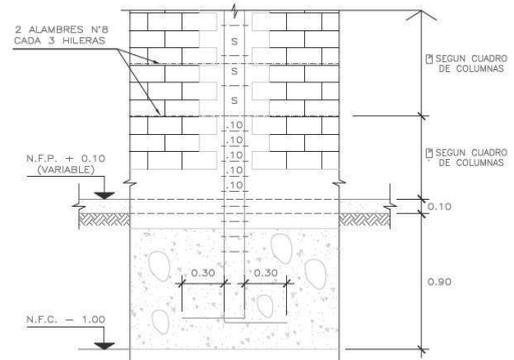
Anclaje de columna con cemento VUF 04 - AC.
